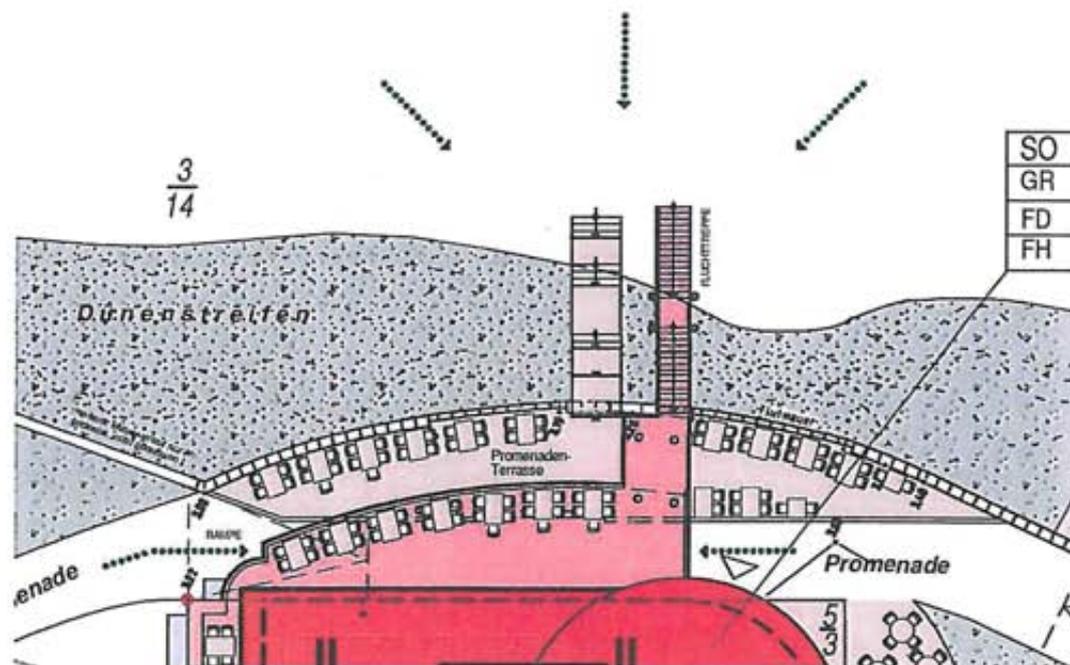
Lageplan Strandzugang, Architektur - und Planungsbüro Dipl.-Ing. Roger Krancher
